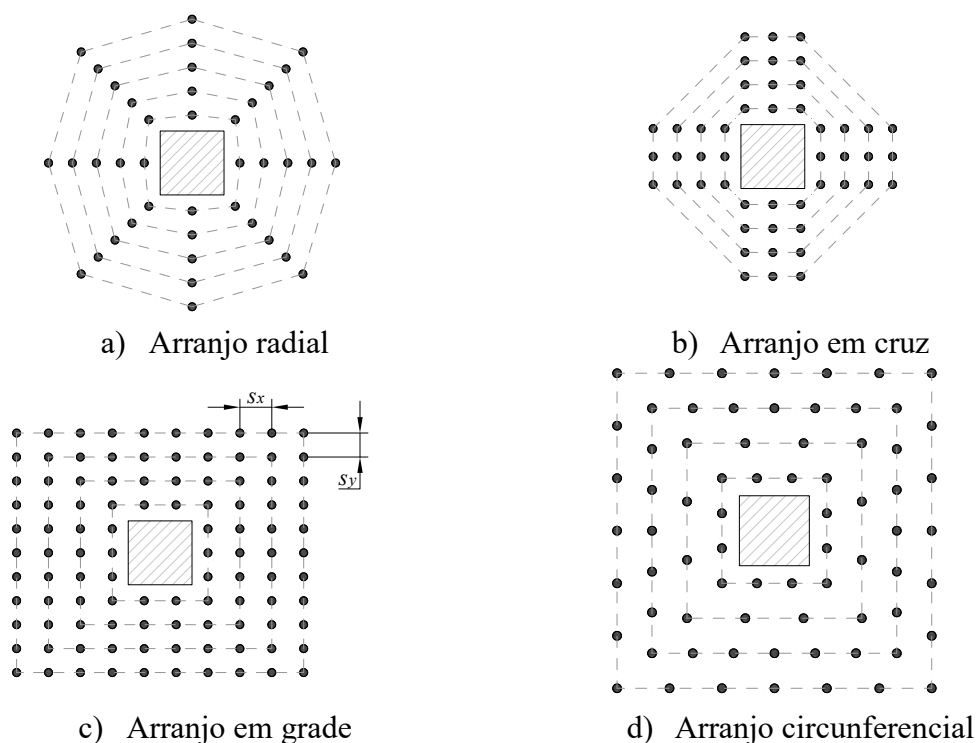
Arranjos possíveis de armaduras de cisalhamento
